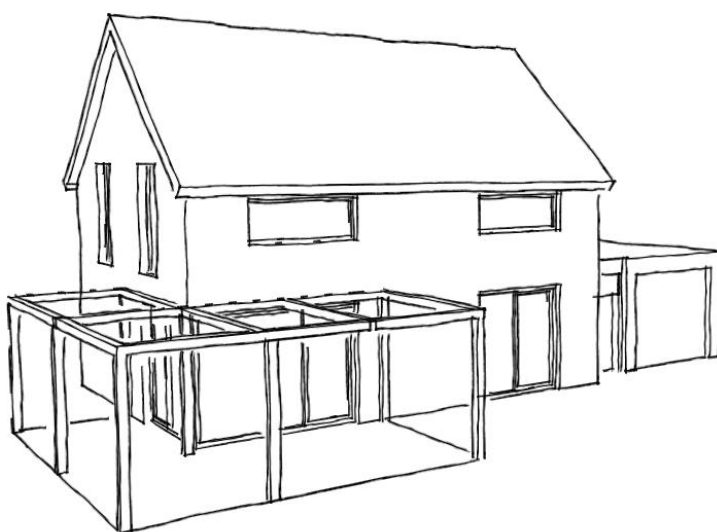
Jihovýchodní pohled, zdroj: autor
